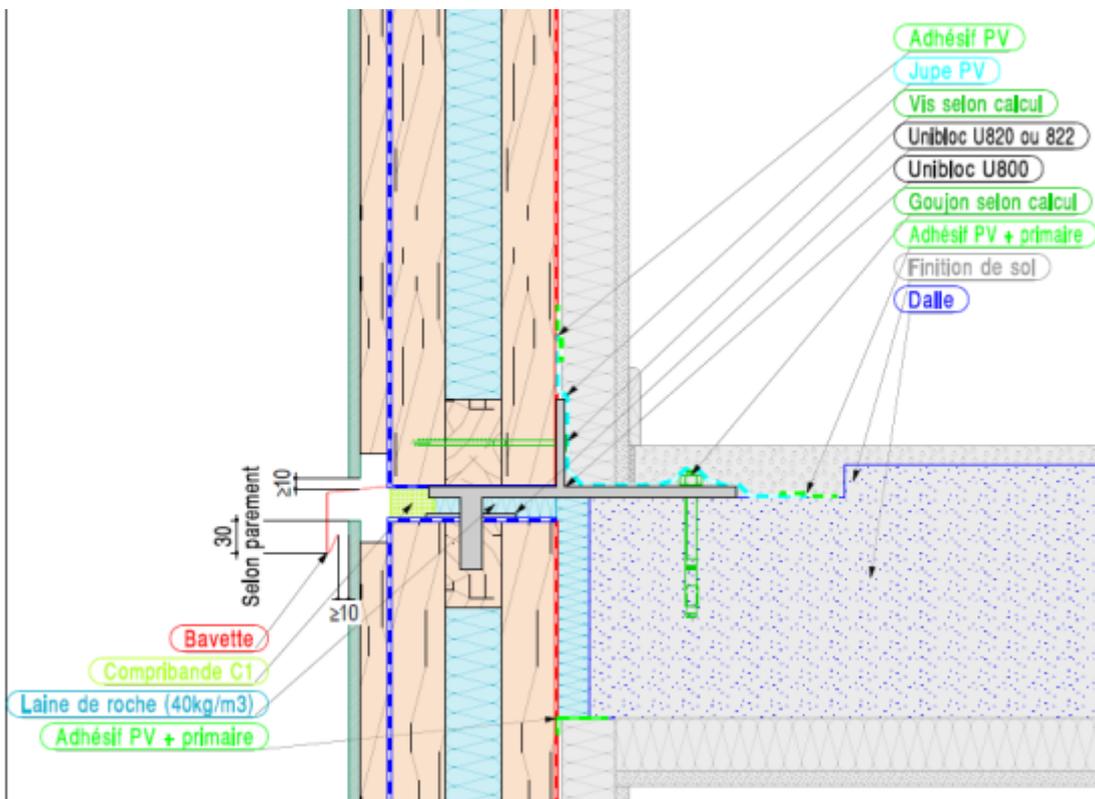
Raccord de panneaux sur dalle béton avec réservation / coupe verticale
